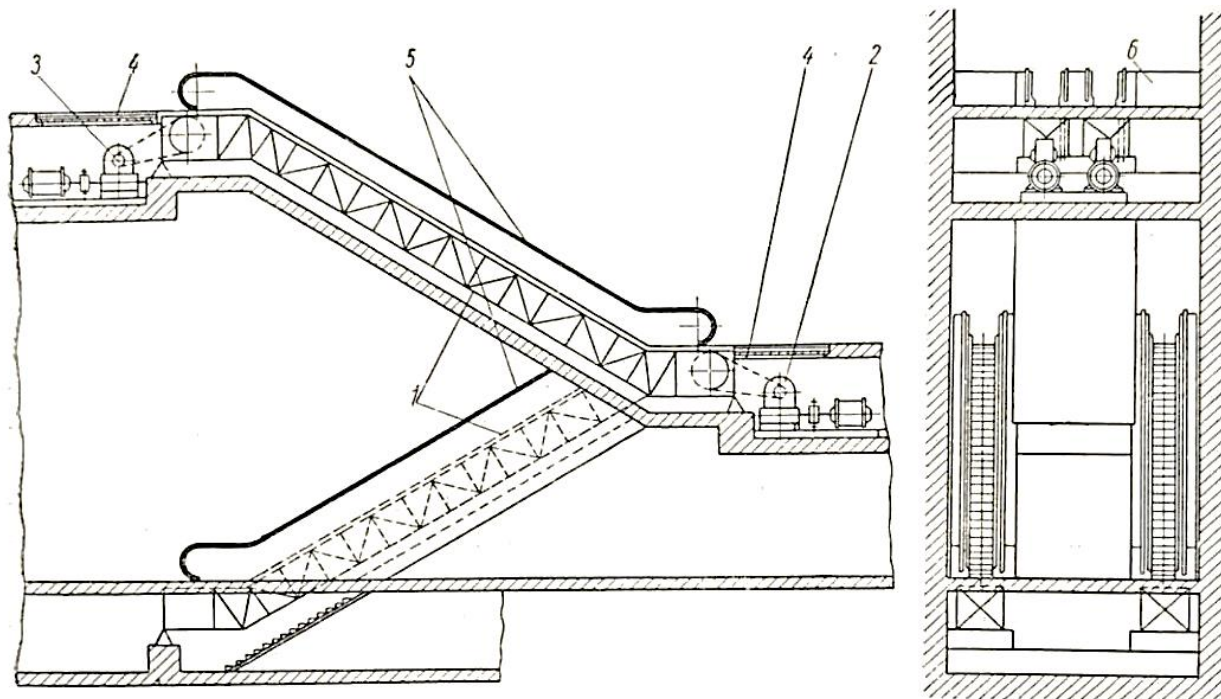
Схема двухмаршевой эскалаторной установки
